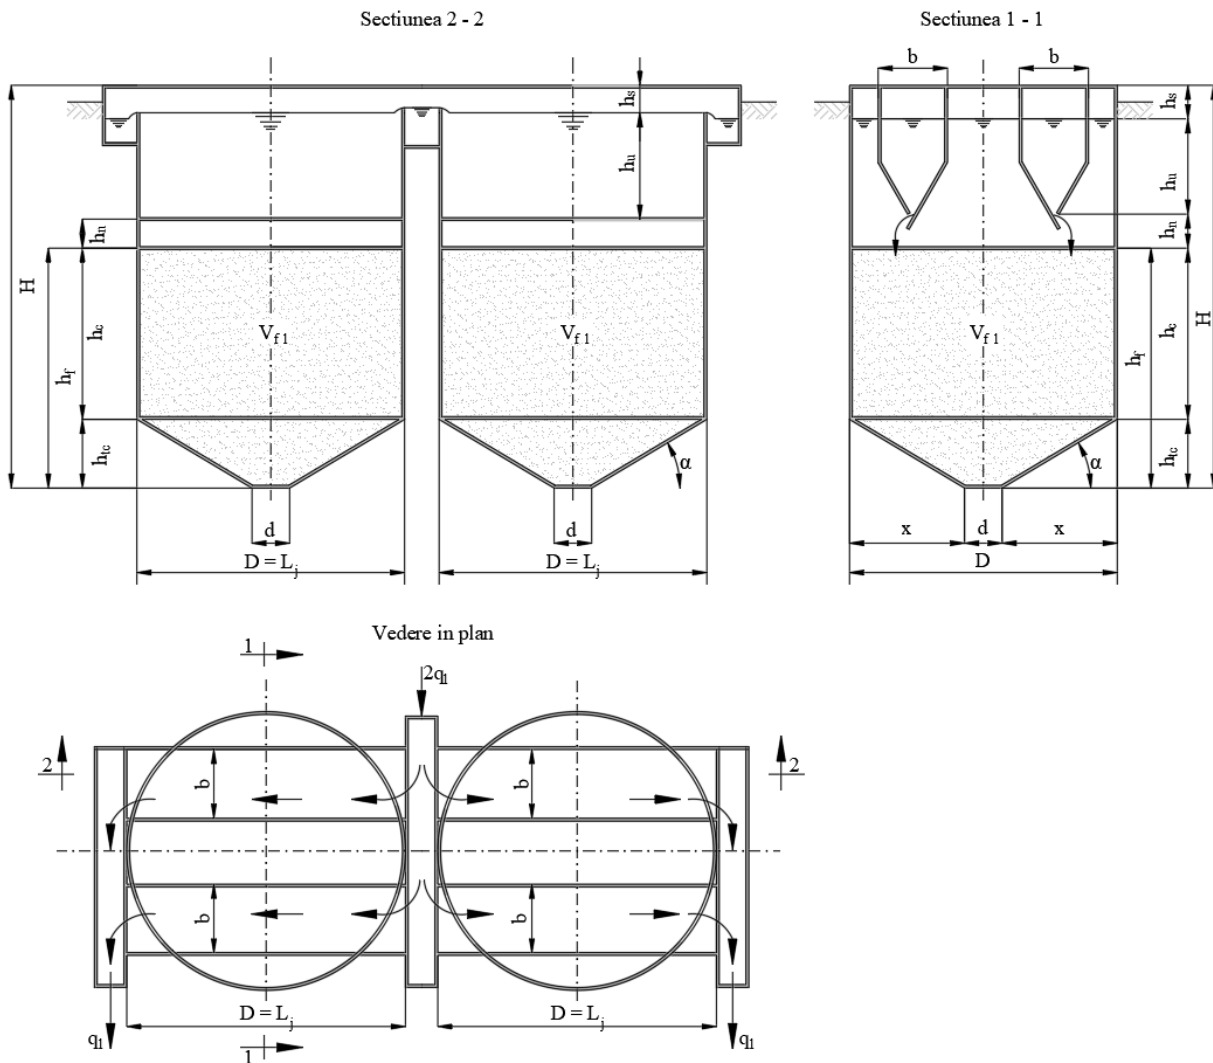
Decantare cu etaj. Dispoziție în plan și secțiuni caracteristice.
